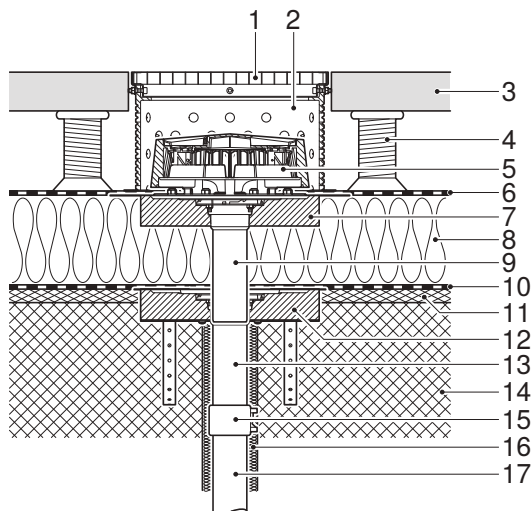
Montage dans toiture massive isolée avec pare-vapeur et revêtement d'étanchéité, carrossable
